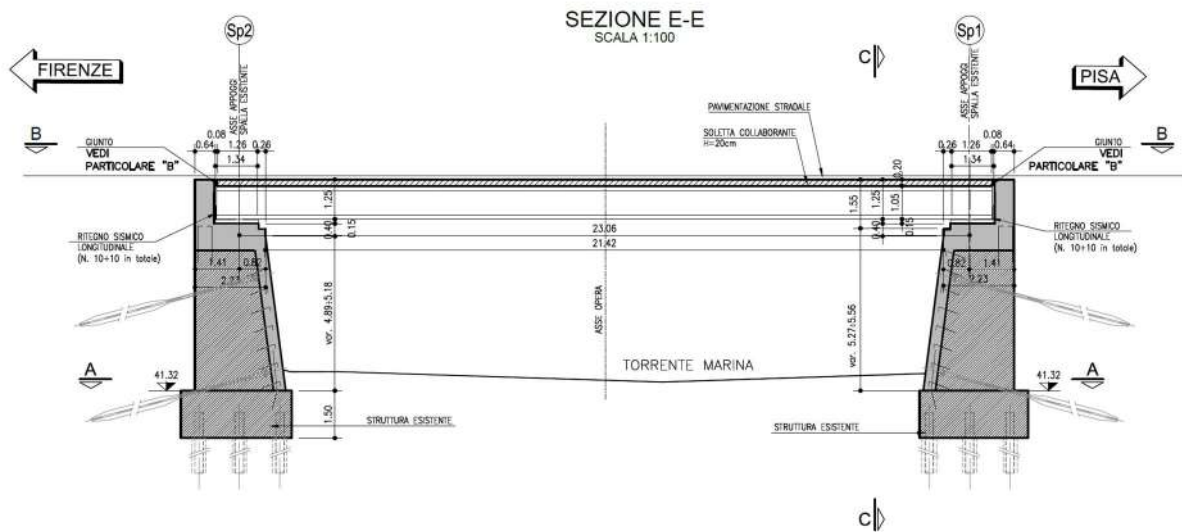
Ponte sul T. Marina. Sezione longitudinale.
